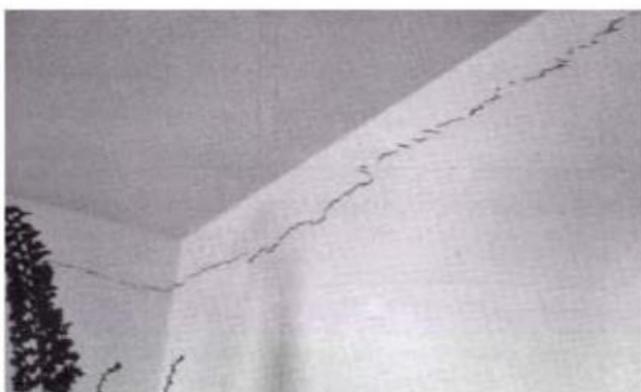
Fissura horizontal na alvenaria por movimentação térmica da laje de cobertura. Fonte: THOMAZ (1989).
